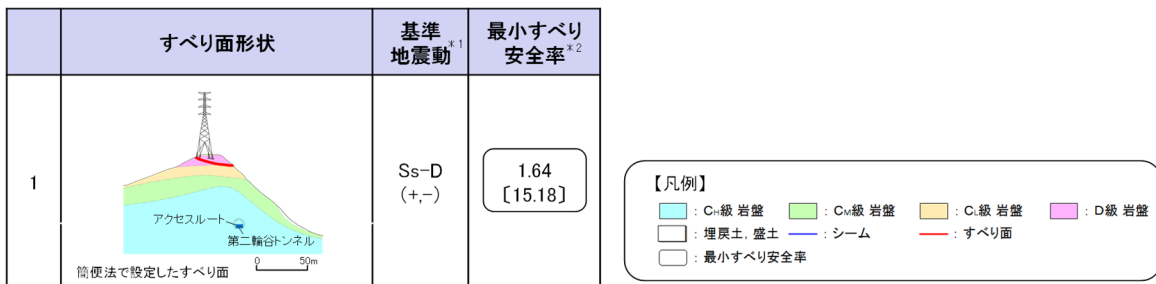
解析モデル図 (B-B' 断面)
